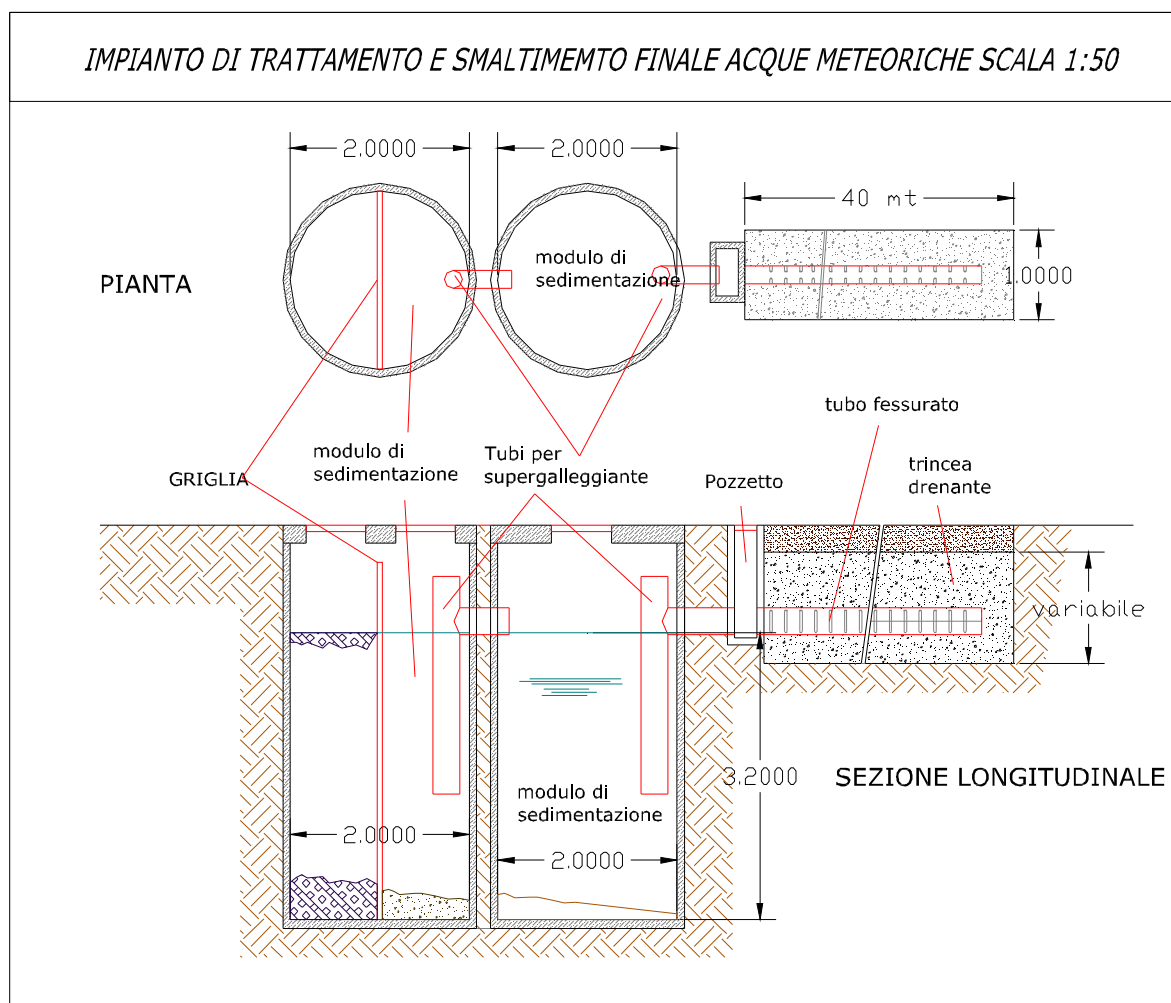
Particolare dell'impianto di trattamento primario e del collegamento alla trincea drenante
